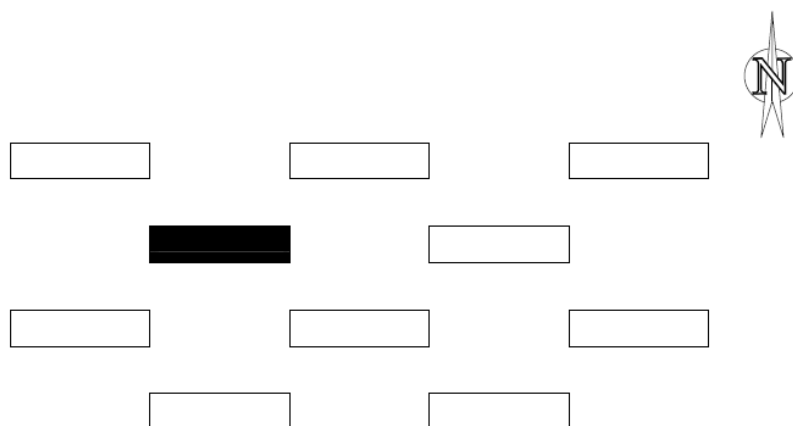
Implantação do parque de muretes; indicação do murete utilizado
